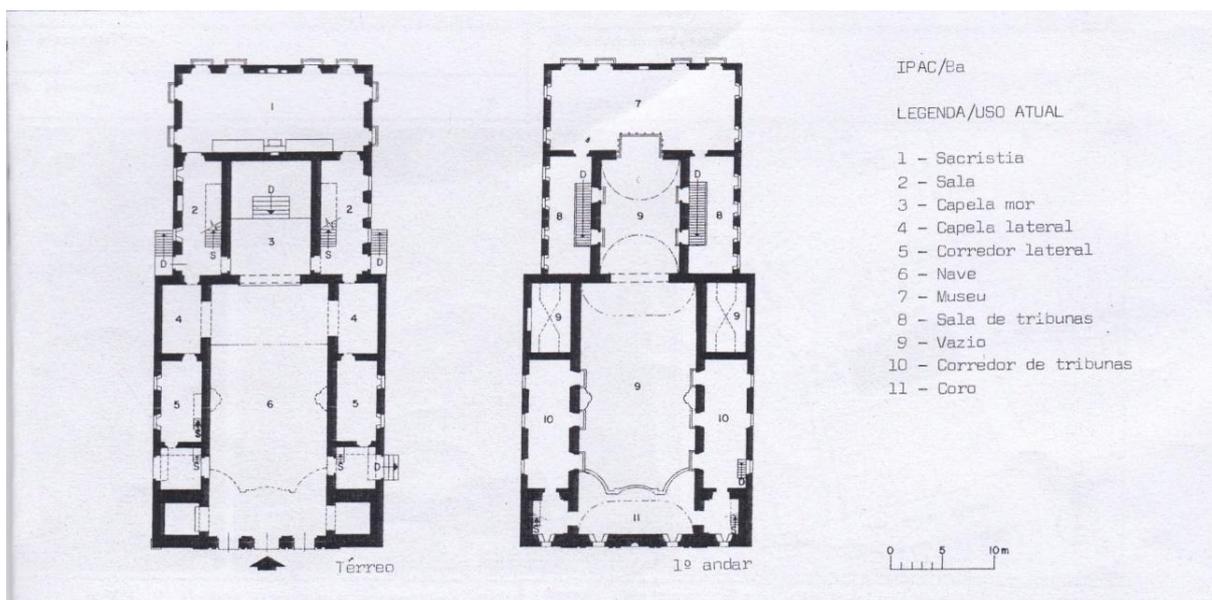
Planta baixa da Igreja Matriz de Cachoeira, IPAC/Ba.
